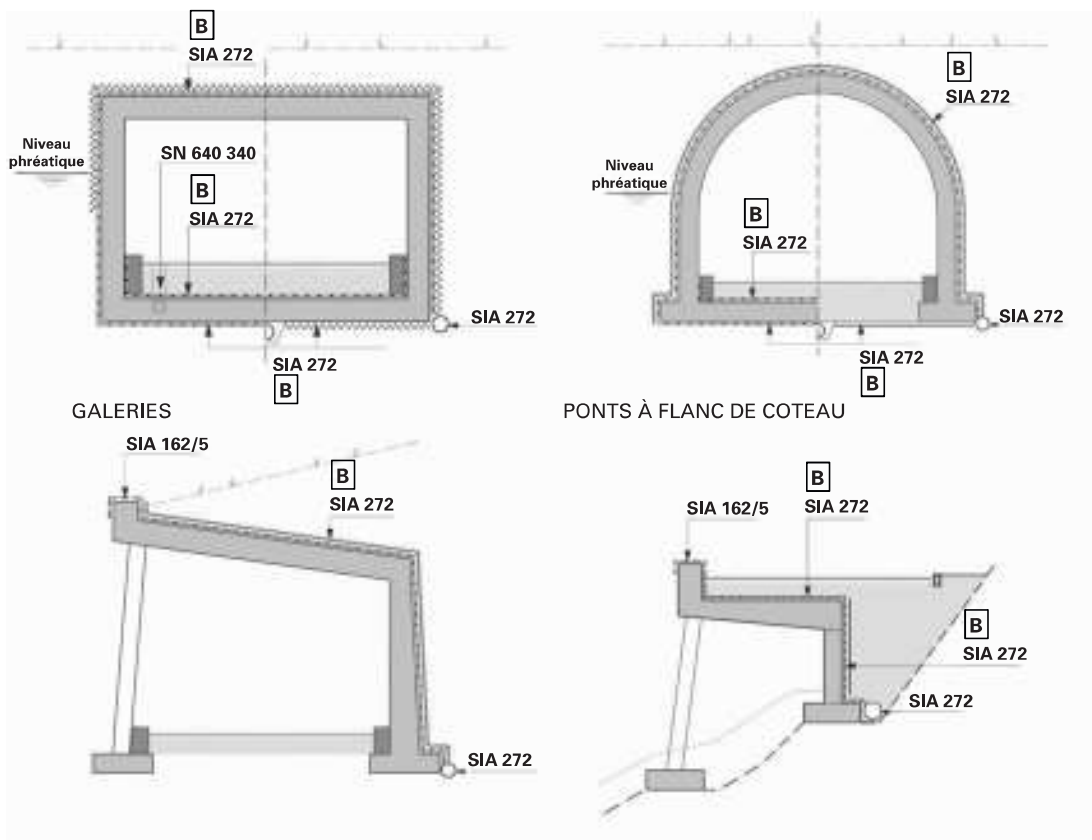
Groupe d'application B2: Ouvrages construits en souterrain
